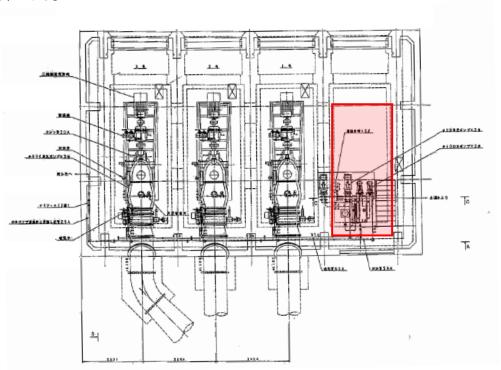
ポンプ室平面図 (赤枠内は増設可能スペース)
